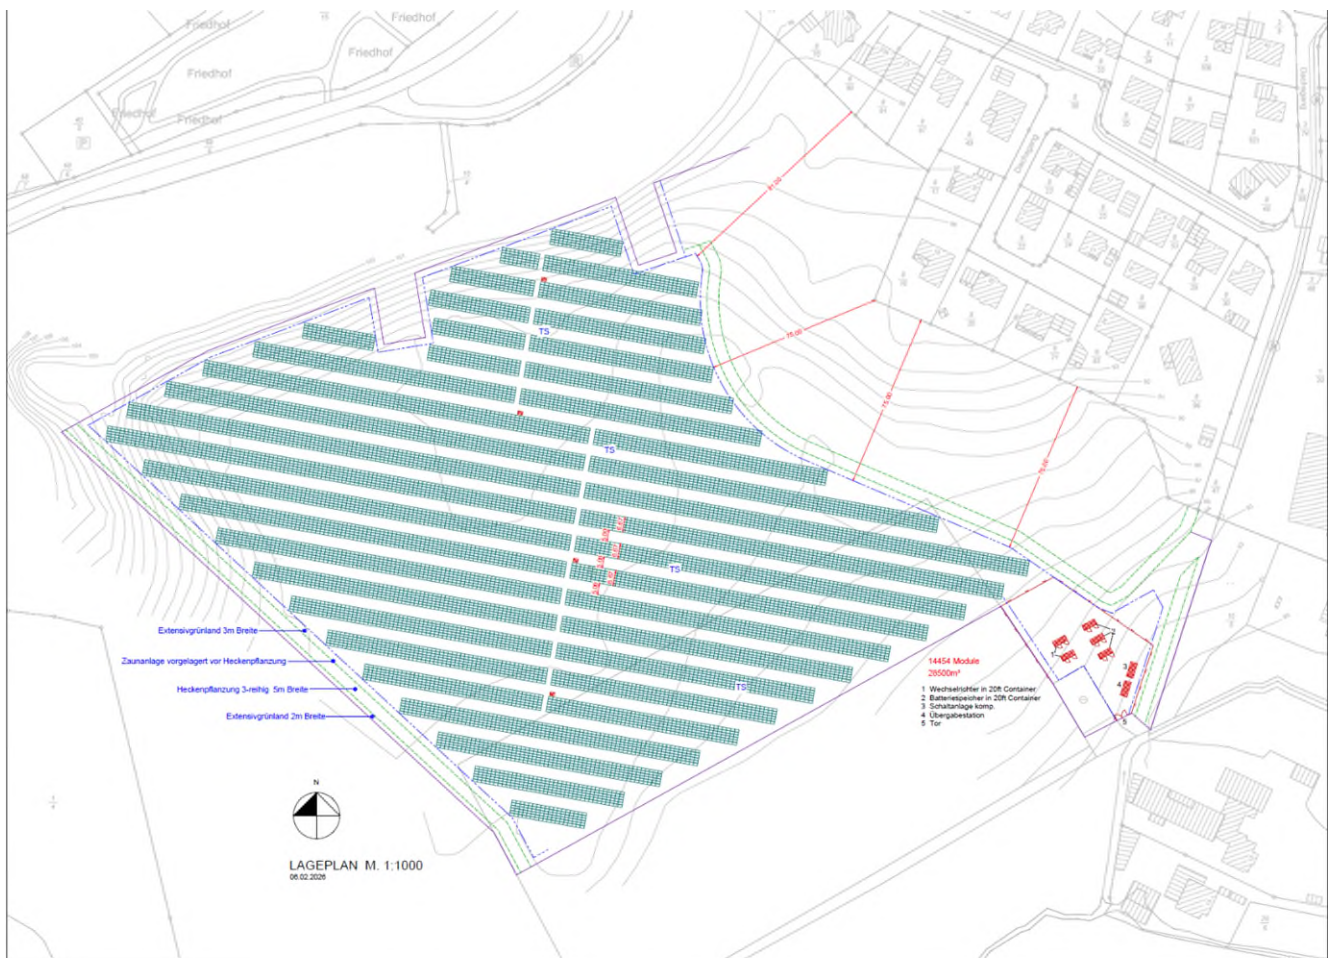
Grundriss (Quelle: Layoutplan, Planet in Green GmbH)
